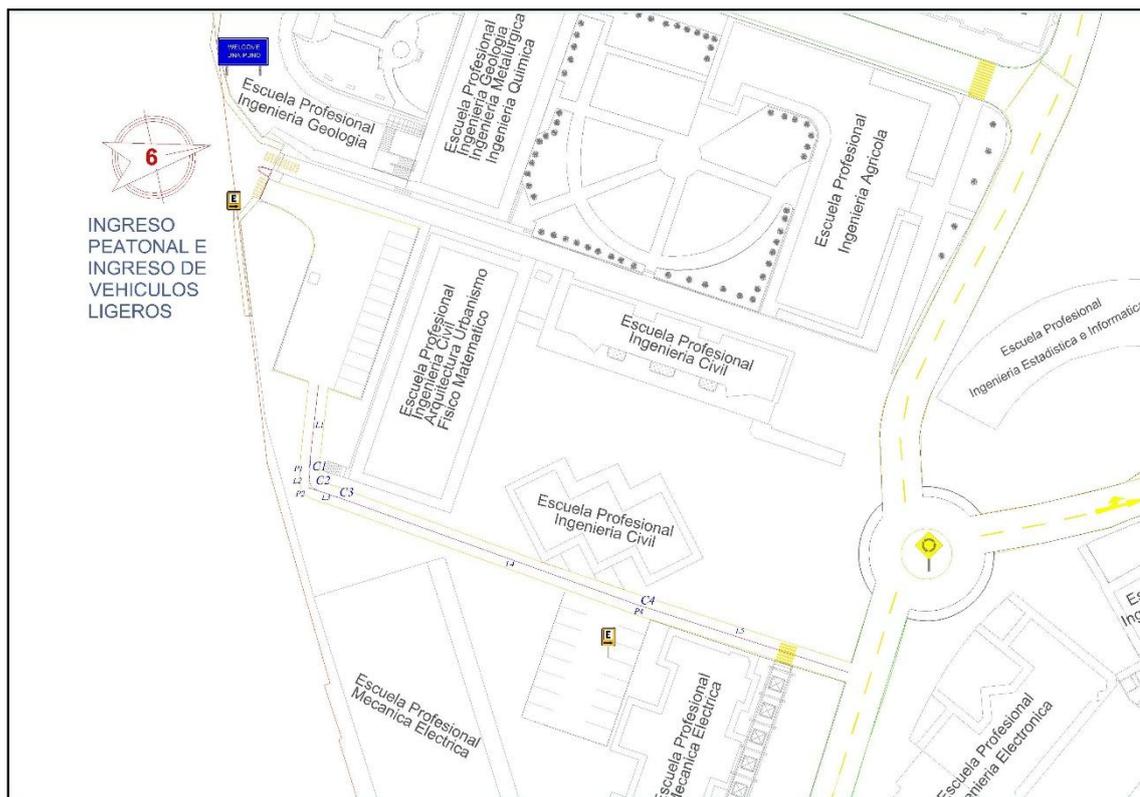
Vía que conectara la puerta de Ingeniería con la vía principal existente.
